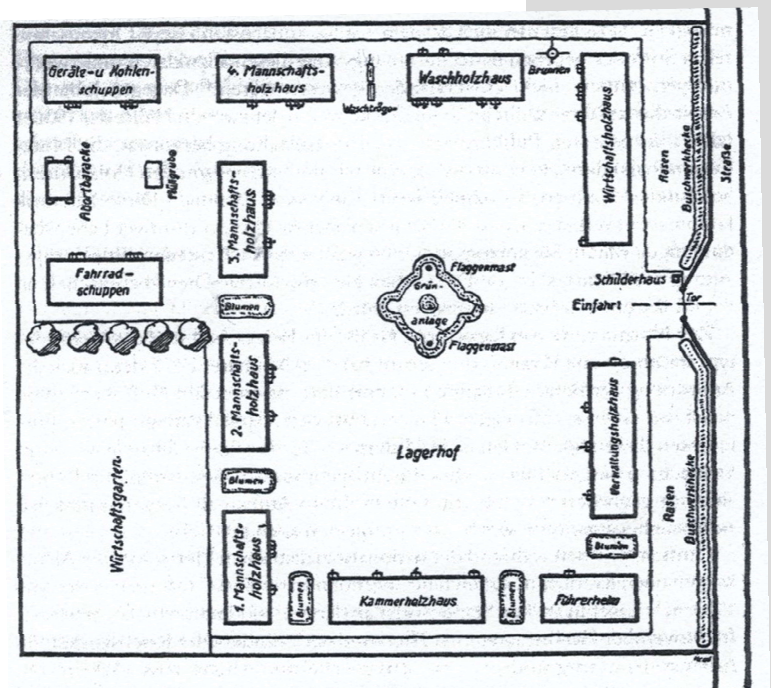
Grundriss eines deutschen Arbeitsdienst-Barackenlagers.⁵⁵
